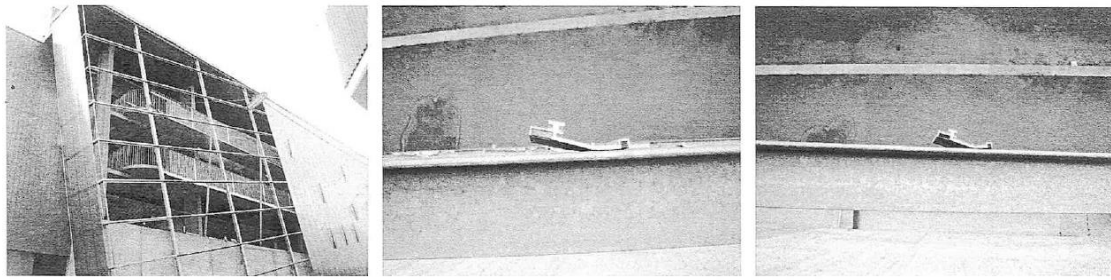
Imagen de la fachada principal destruida-detalles de piezas metálicas de sujeción
